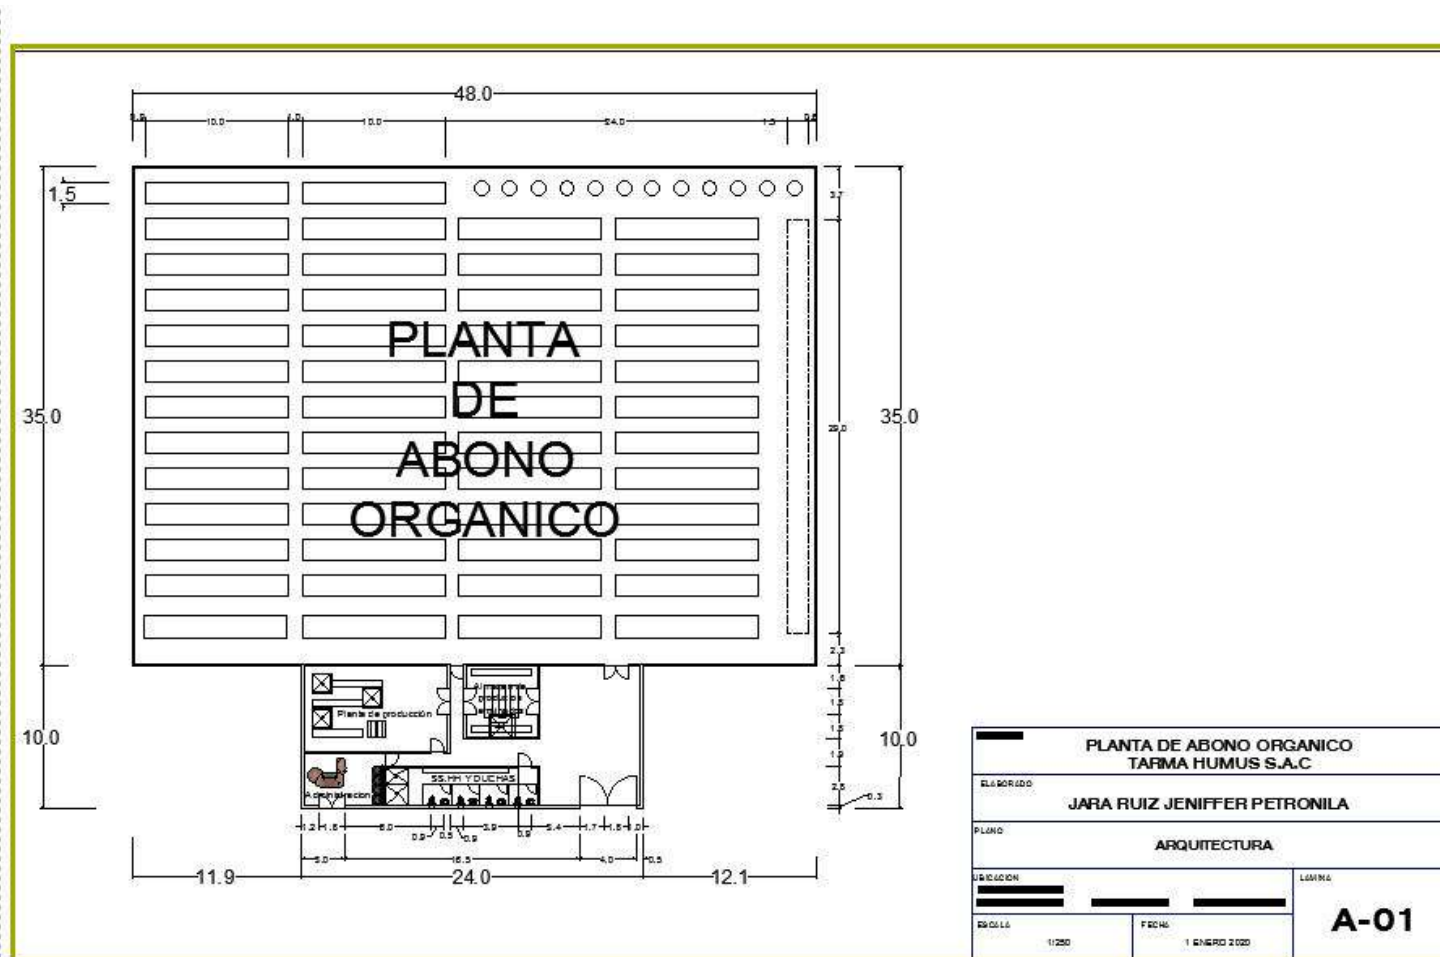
Plano General de la Planta Tarma Humus S.A.C
